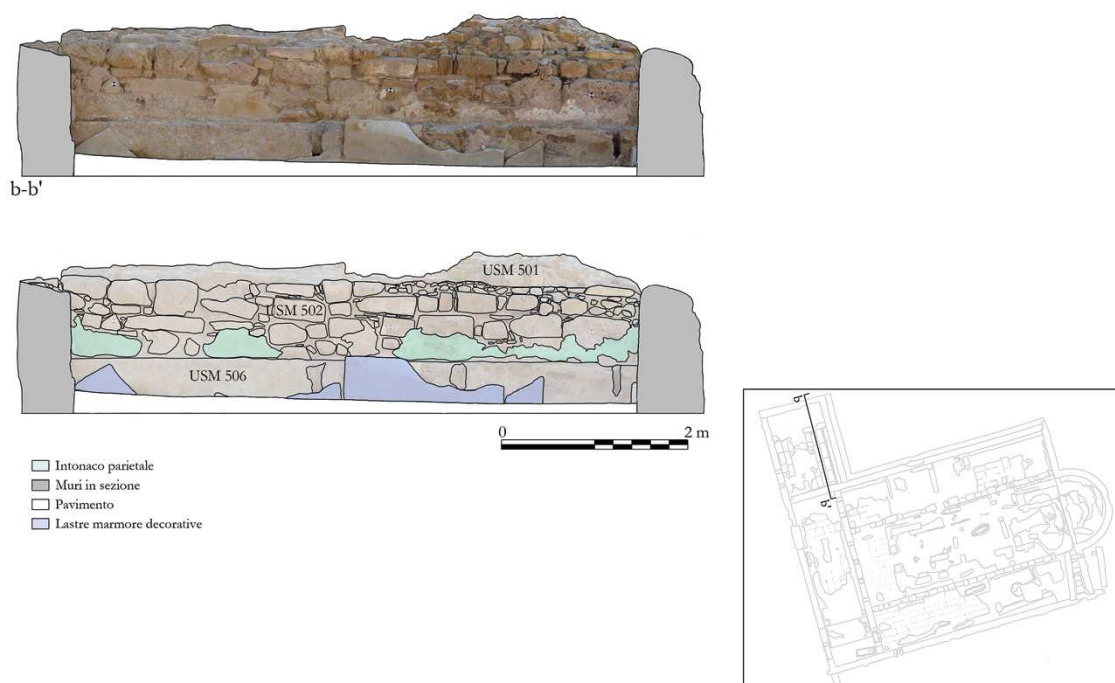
Ambiente 2. Prospetto e sezione longitudinale (b-b') (foto ed el. C. Mendolia; © Archivio disegni SAIA NIG 8511).
